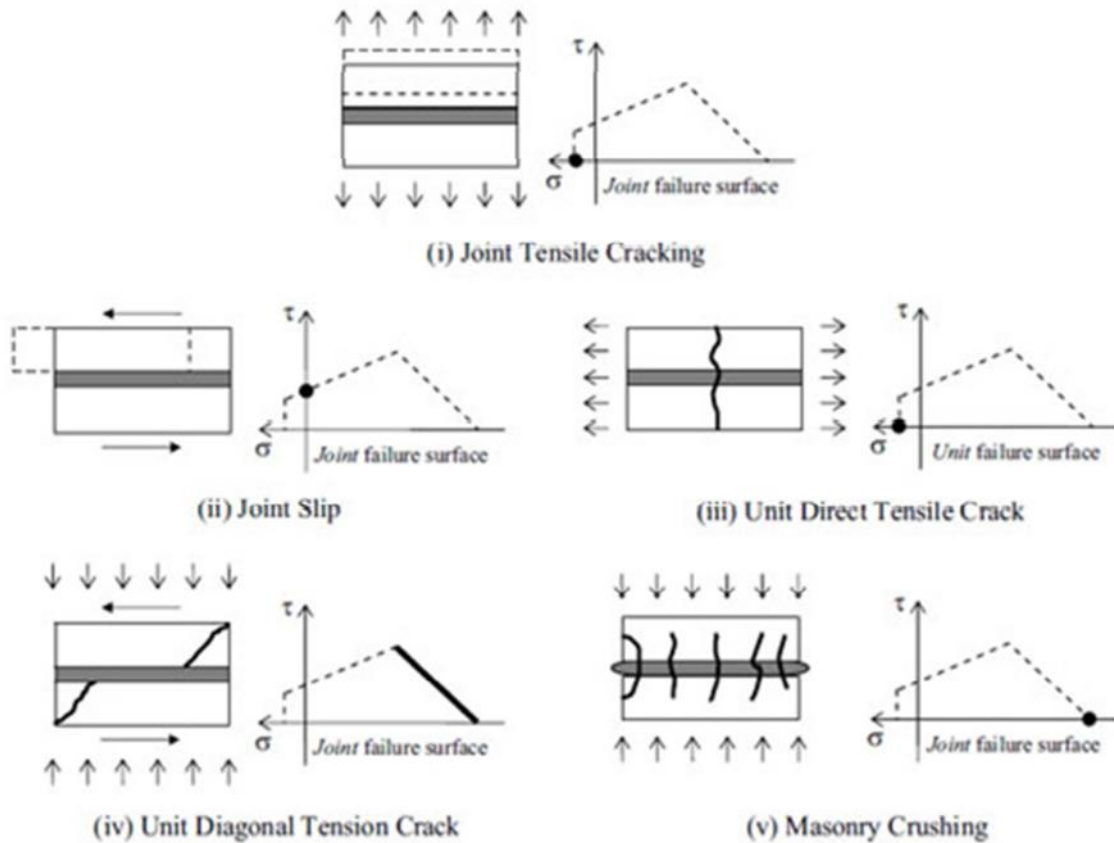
Mecanismos de rotura en la mampostería: a) fisuración por tensión en la junta; b) deslizamiento en la junta; c) fisuración de la unidad por tensión directa; d) fisuración de la unidad por tensión diagonal; e) aplastamiento de la mampostería. (Lourenco & Rots, 1997)
